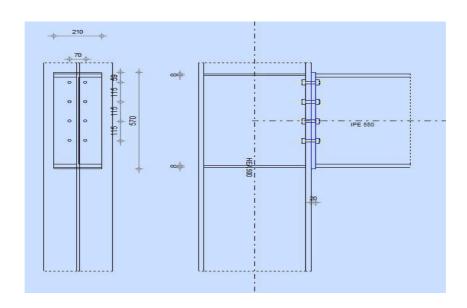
13 : Vue de l'assemblage poteau – poutre maitresse.
